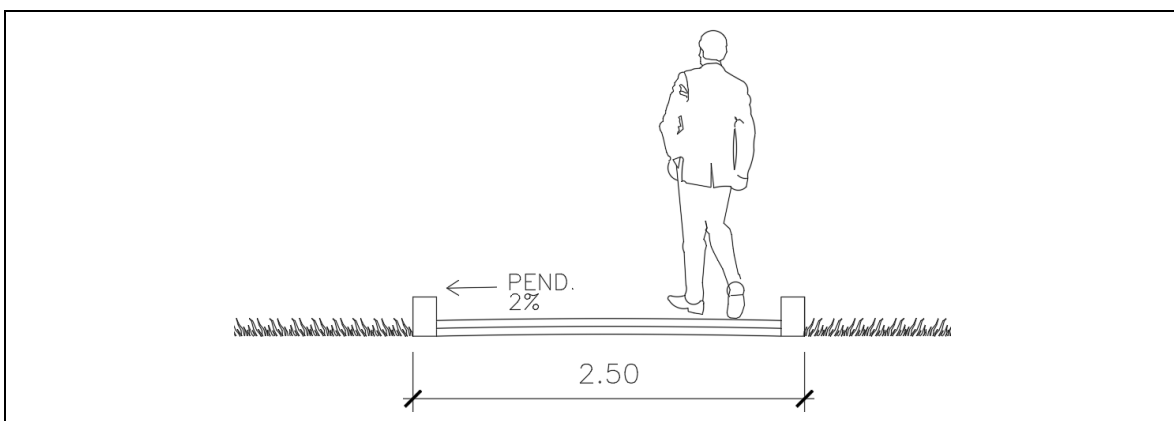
Sección vial en vialidades tranquilizadas tipo "B"
